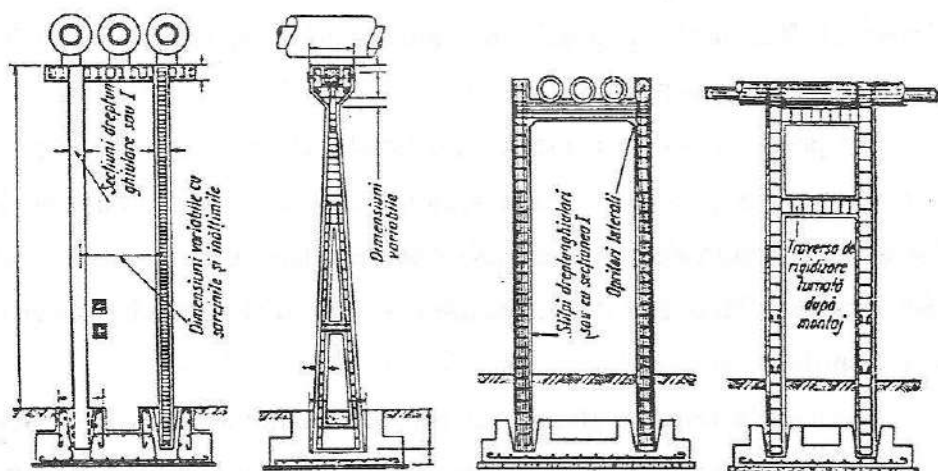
Armarea unui suport din beton armat monolit – reazem fix.
